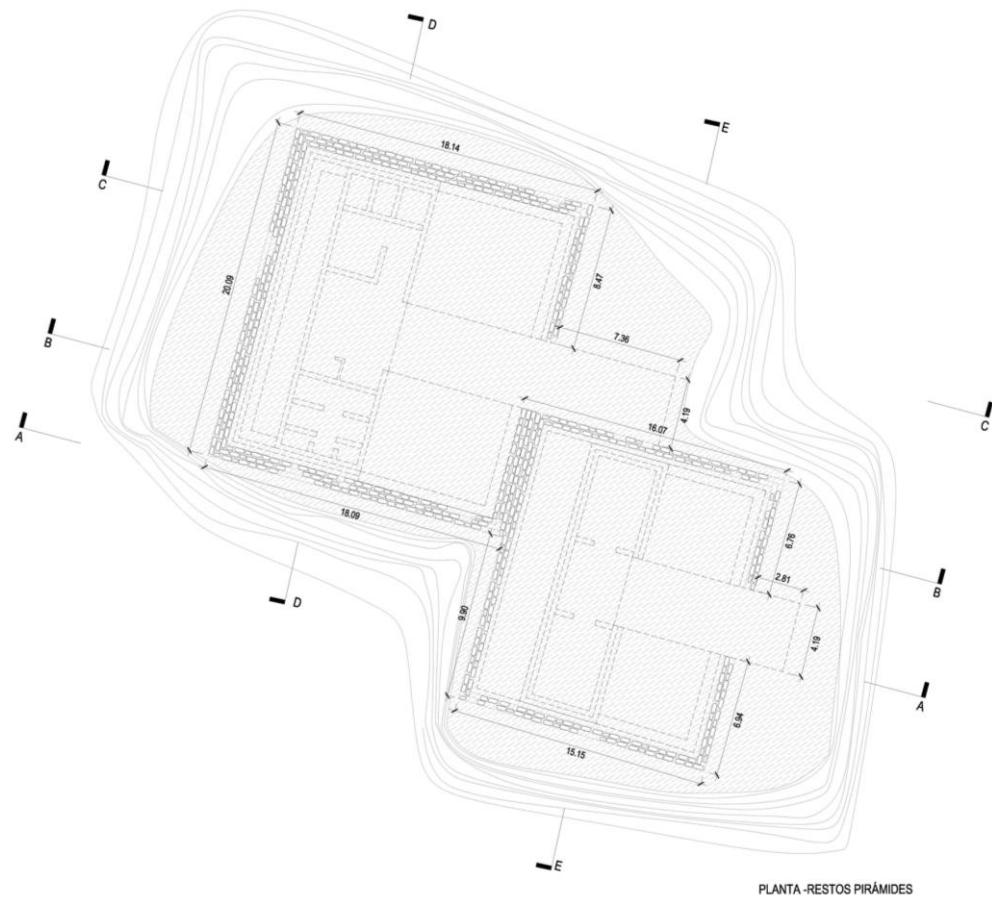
Pirámides adosadas prehispánicas- Planta Elaboración propia
